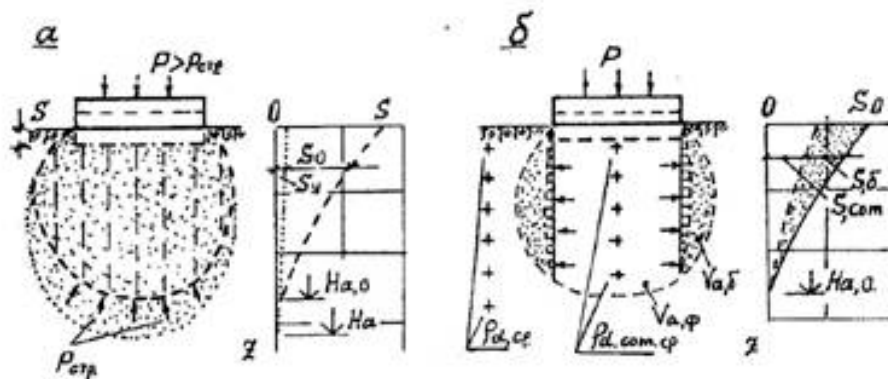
Схема процессов деформирования грунтов в основании фундамента
